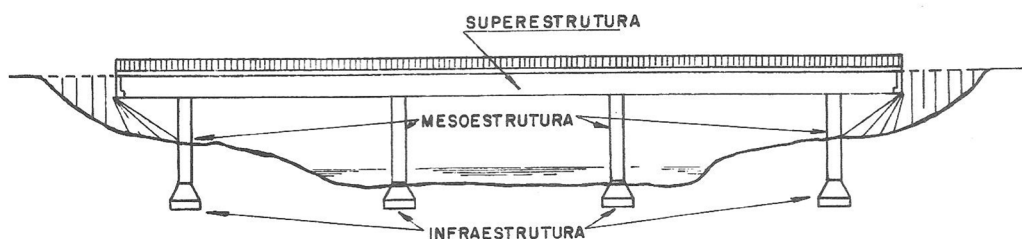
Vista geral de uma ponte com as suas principais estruturas (PFEIL, 1983)
